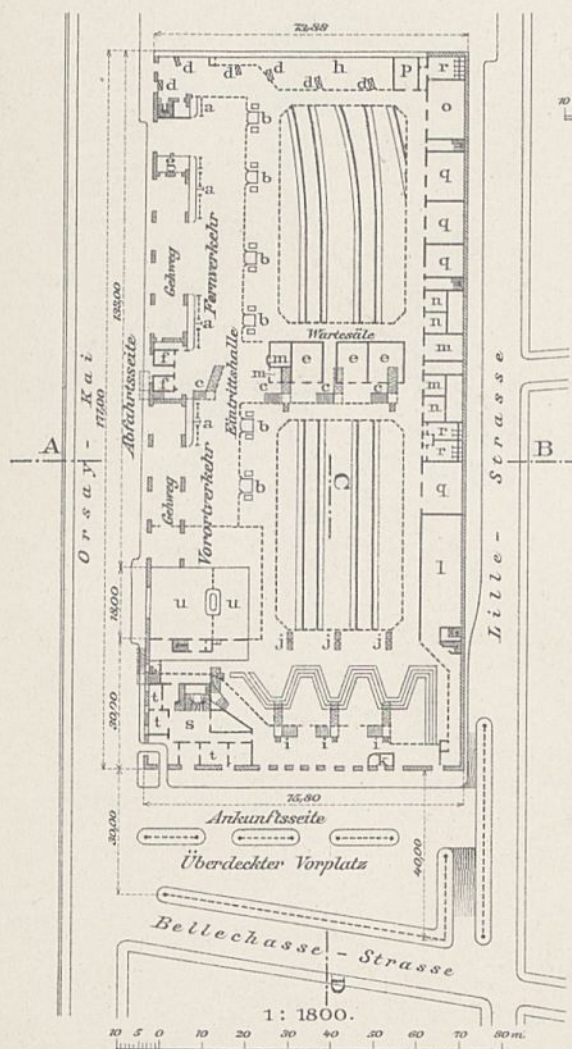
Grundriss des Empfangsgebäudes des Orsay-Bahnhofs.
